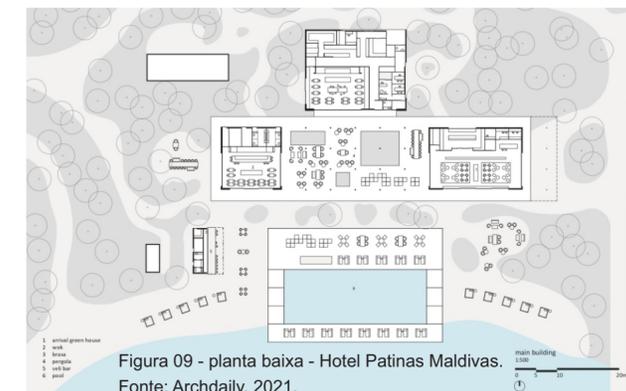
planta baixa - Hotel Patinas Maldivas.
